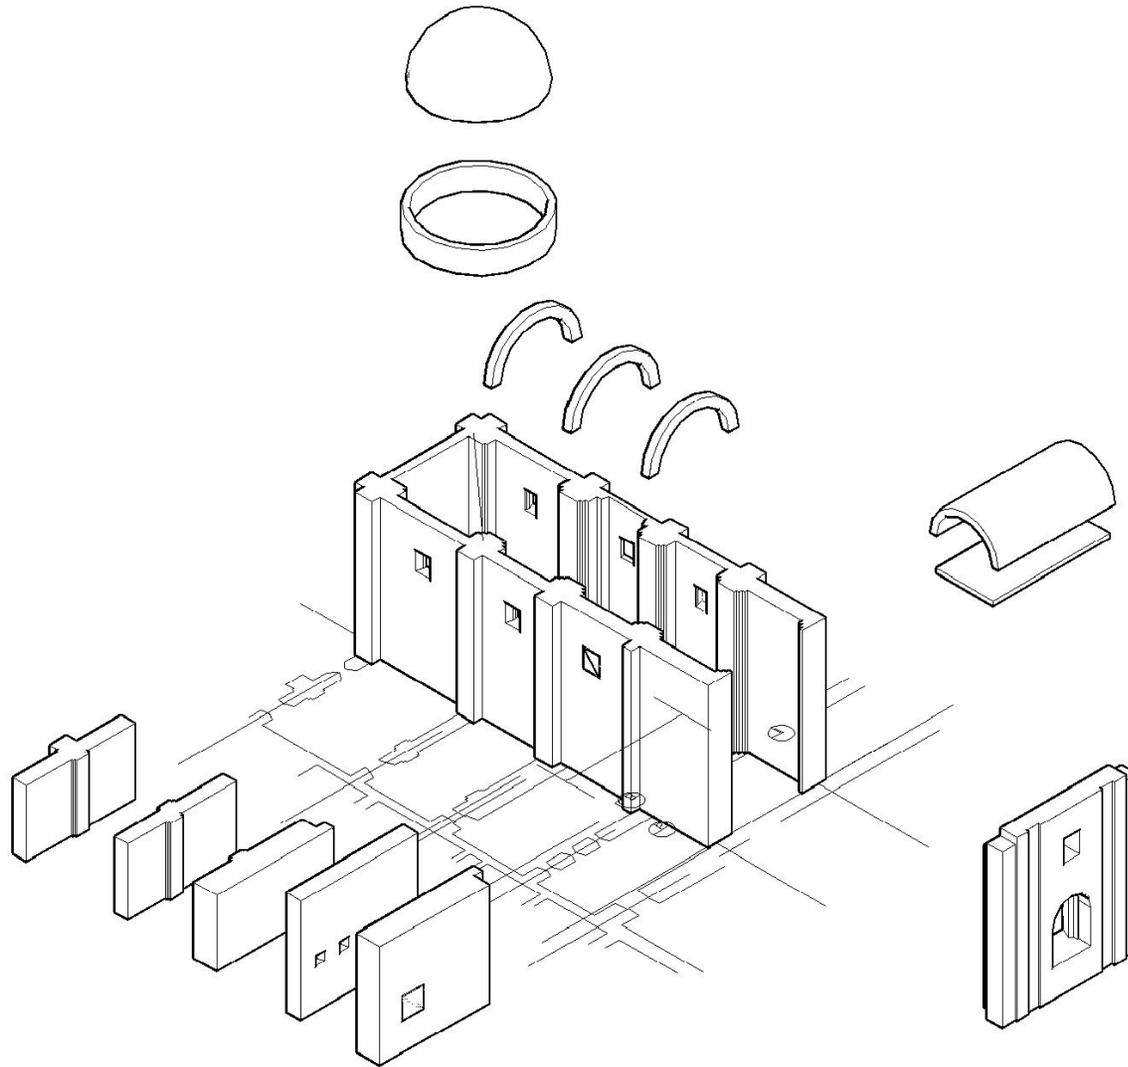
Planta y elevación del templo de Santa Teresa.<sup>206</sup>
